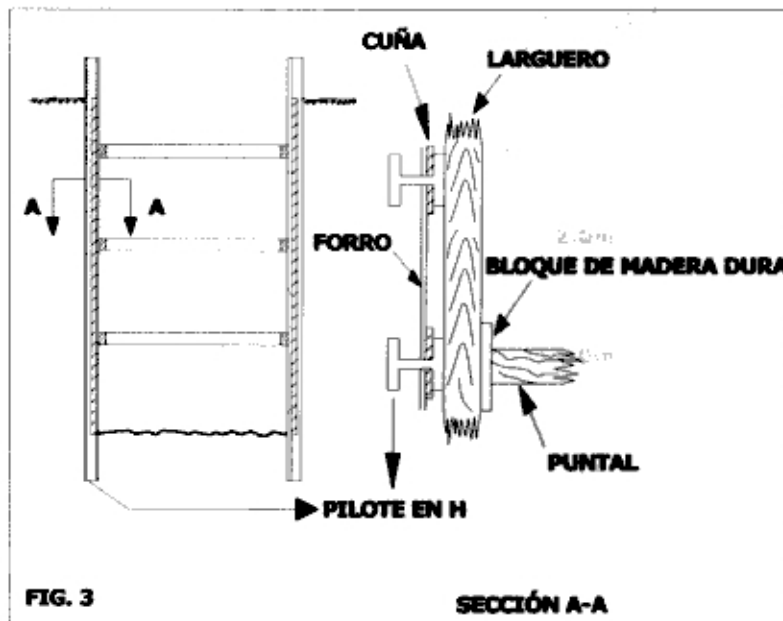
Apuntalamiento con pilote H y corte de A-A
